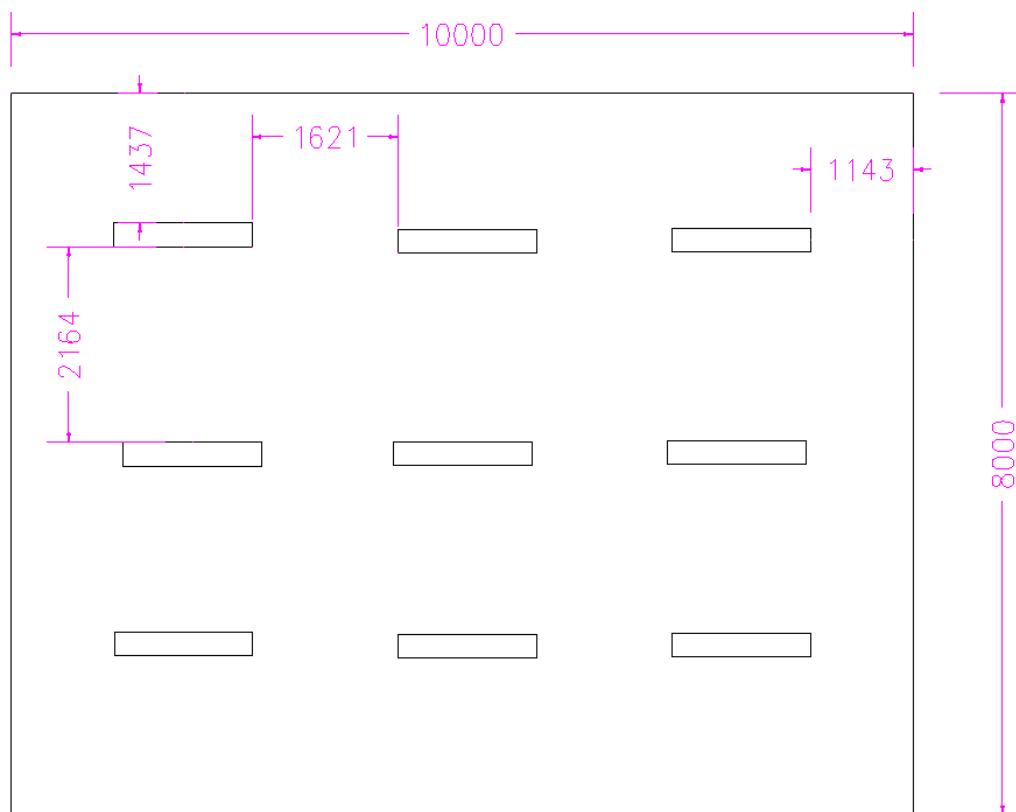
План помещения и размещения светильников с люминесцентными лампами.
